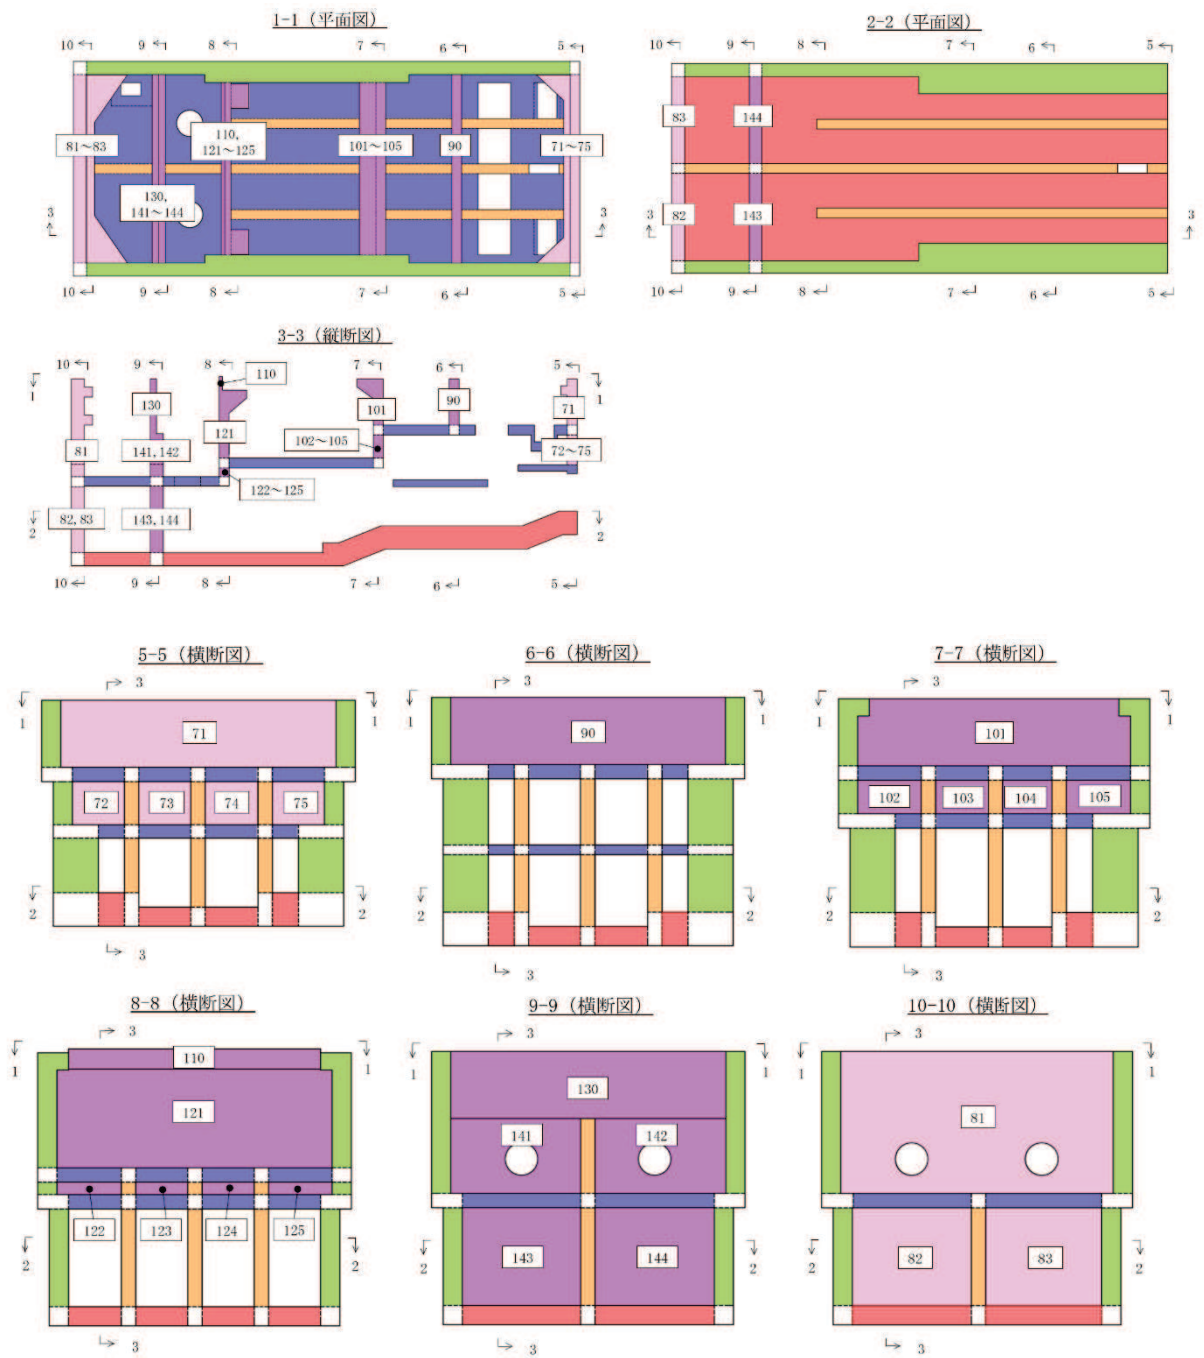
(3) 海水ポンプ室 評価位置図 (曲げ・軸力系の破壊及びせん断破壊)
